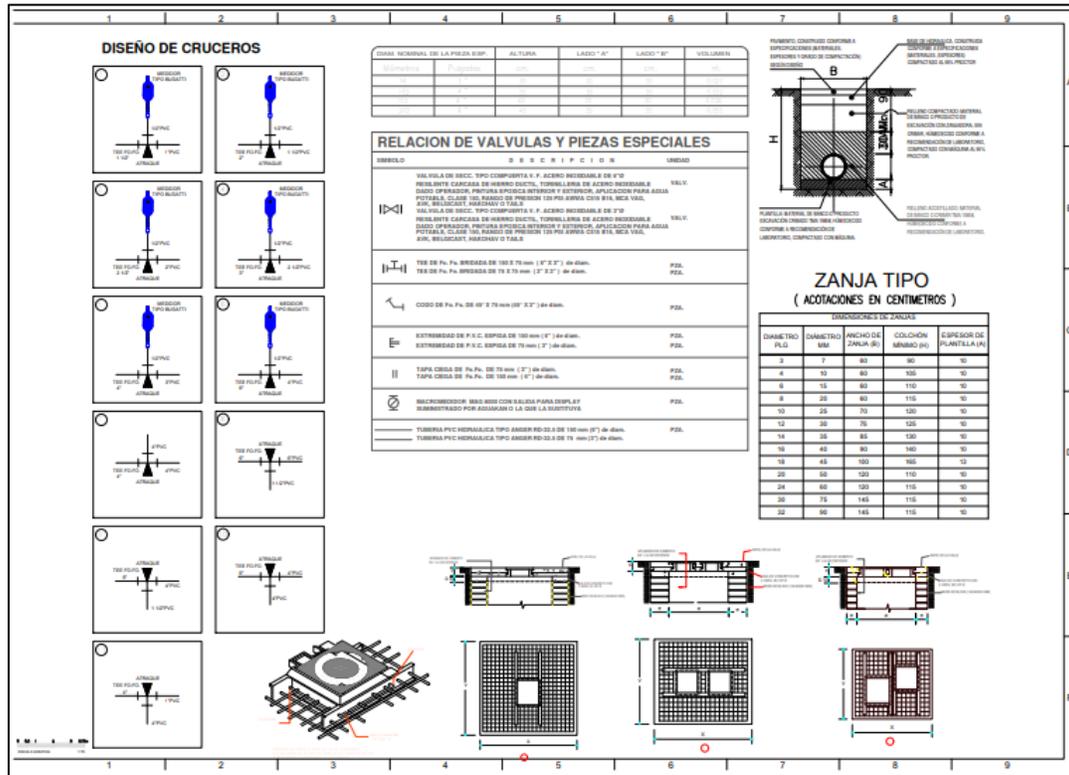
Plano de detalles arquitectónicos de instalaciones hidráulicas.
